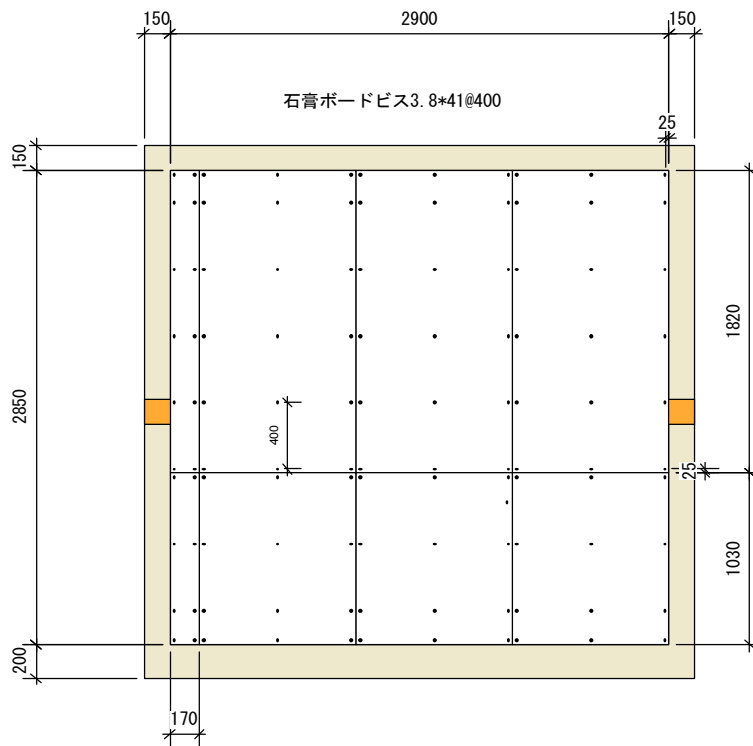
床面 1 枚目・強化石膏ボード施工図
